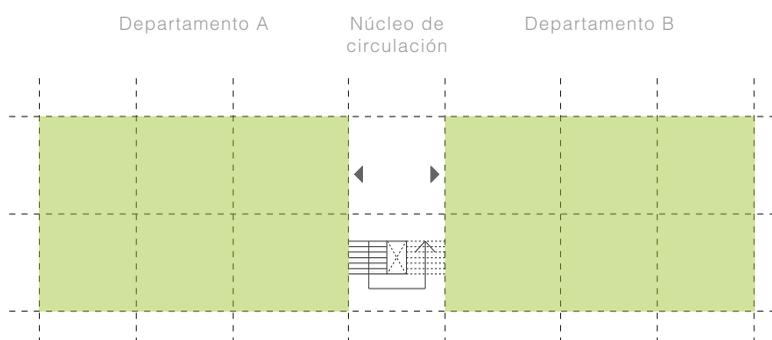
Planteamiento arquitectónico del conjunto habitacional
